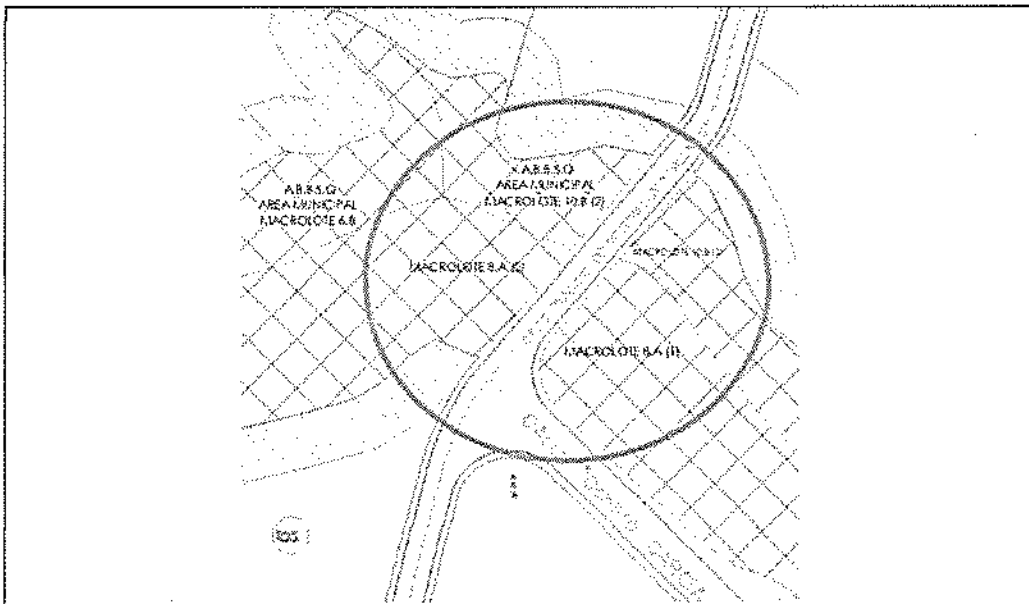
Corrección en el plano de reforma del ANHyC Santa Ana
